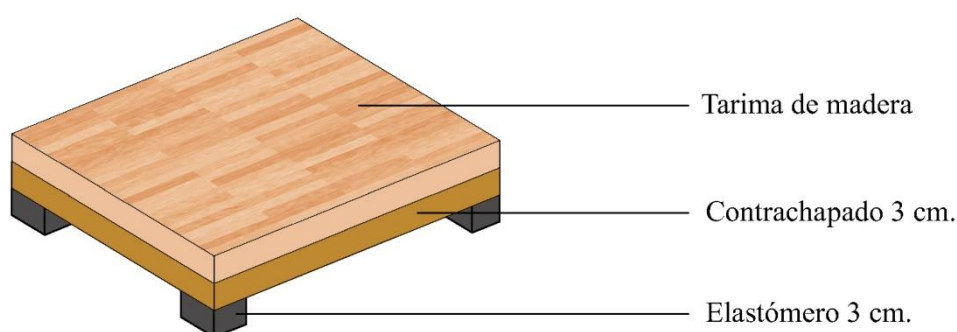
Detalle de la solución constructiva de un pavimento acabado en madera.
